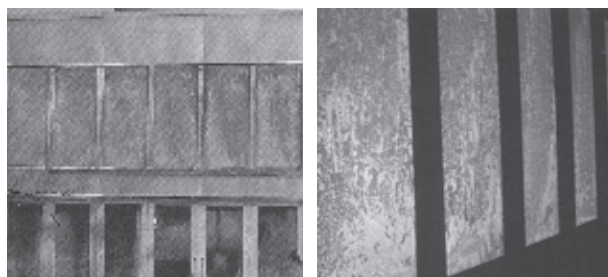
Imágenes de vidrios de Planta Piso con escarcha en el interior.
